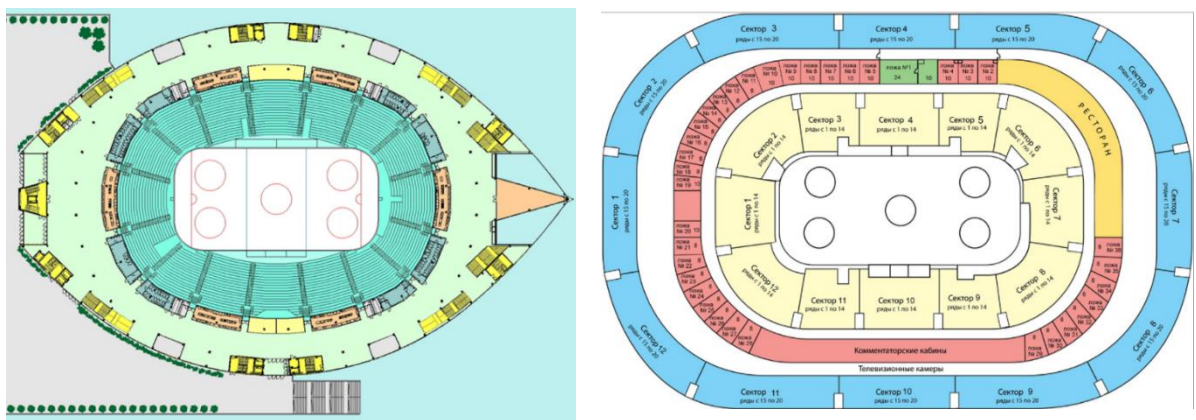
Примеры формирования планировочного решения ледовой арены
